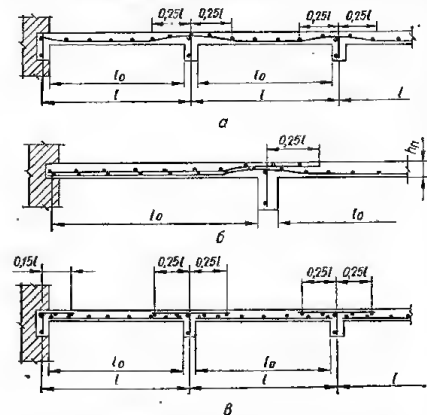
Армирование многопролетных балочных плит: а — непрерывное сварными рулонными сетками с продольным расположением рабочих стержней; б — непрерывное сварными рулонными сетками с укладкой дополнительной сетки в крайнем пролете; в — раздельное сварными рулонными сетками с поперечным расположением рабочих стержней
